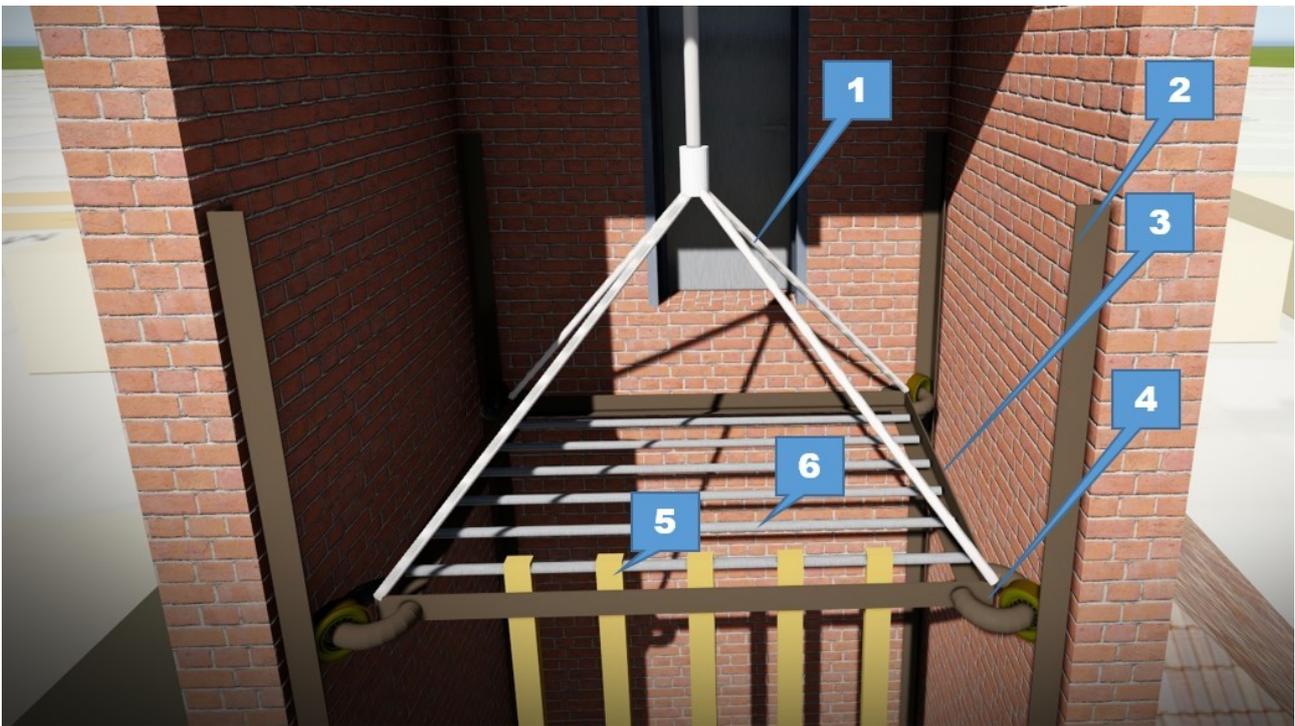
Конструкция подъемного механизма: 1 — стропы крепления подъемной платформы; 2 — направляющие; 3 — неравнобокий уголок; 4 — упорное устройство; 5 — пожарный напорный рукав; 6 — стальной стержень.
